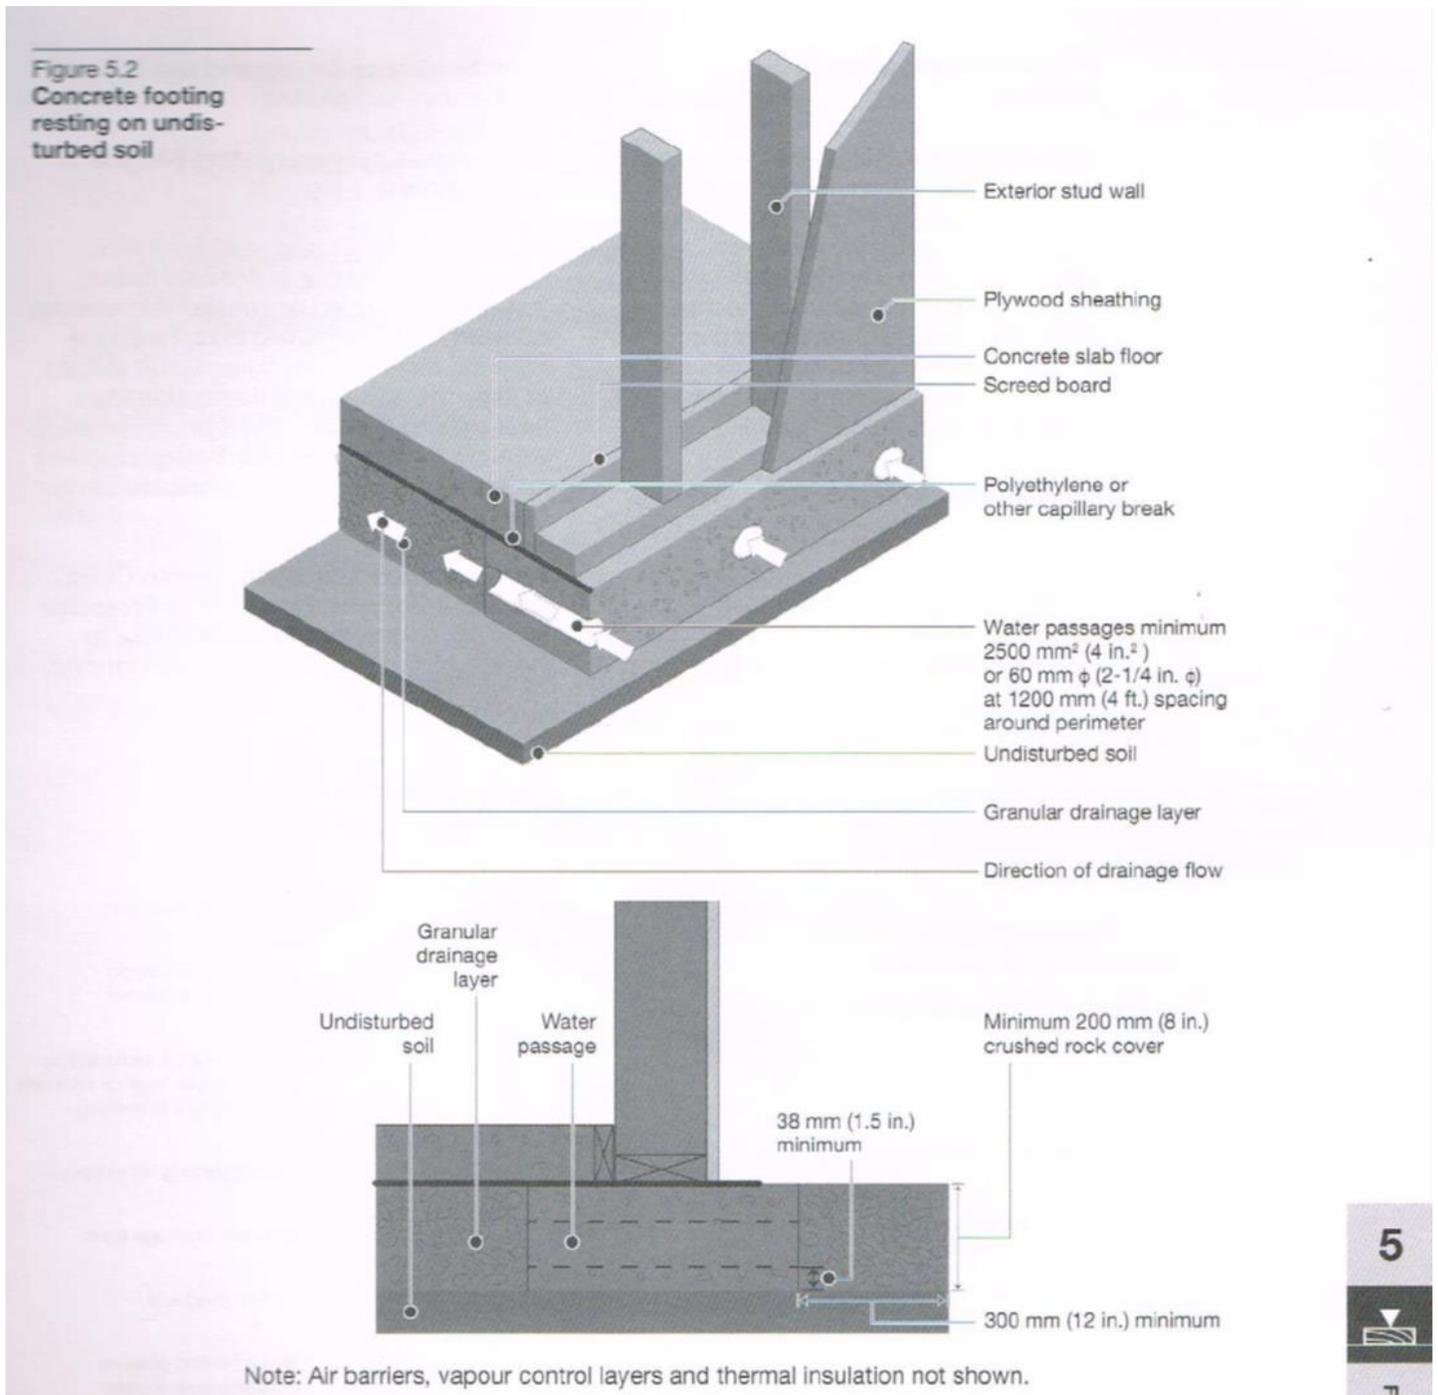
Semelles en béton avec des tuyaux à 1,2m (4 pieds) au centre pour permettre l'écoulement des eaux.
